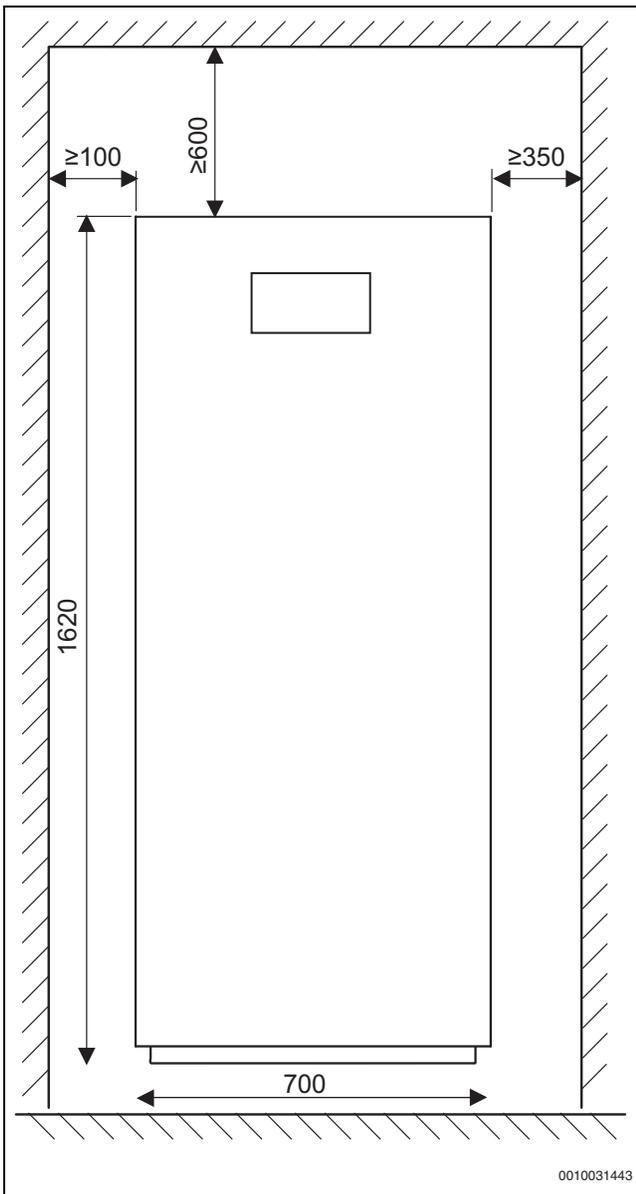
Dimensioni della pompa di calore 22-28 kW
